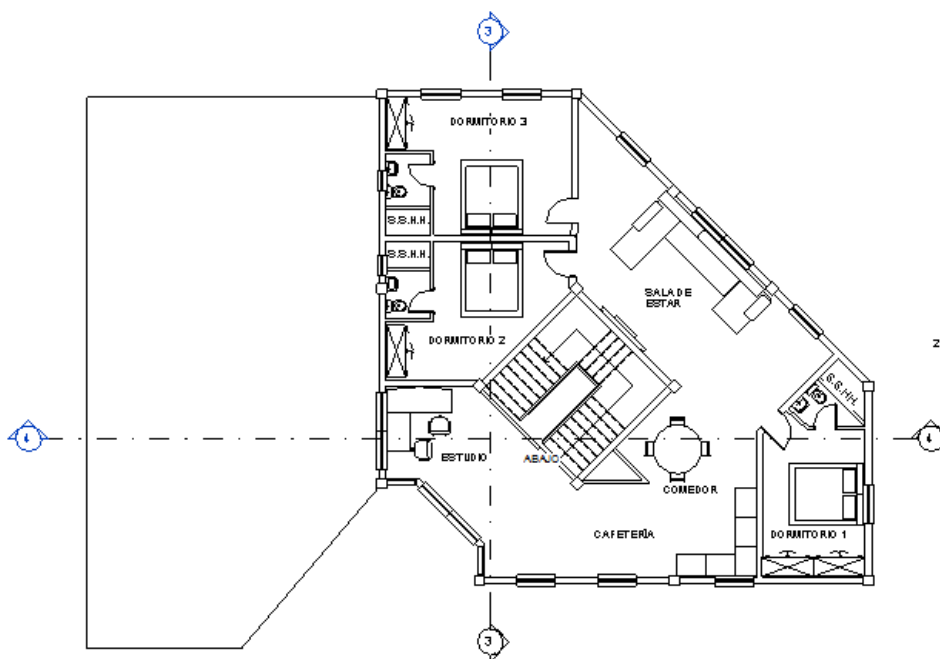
Primera Planta Alta N=+3,40 Hospital del Día
